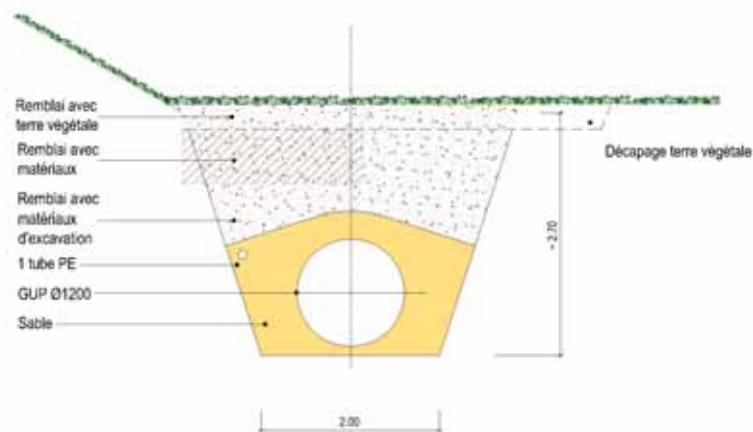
Coupe-type de la conduite (cf. Annexe 1)
